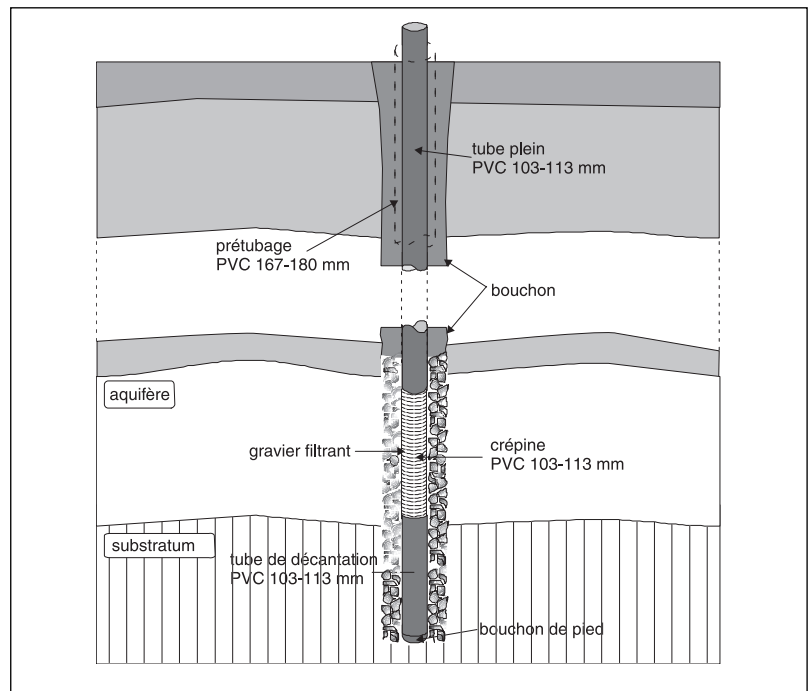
Schéma d'équipement de forage (ACF Ouganda, 1997).
